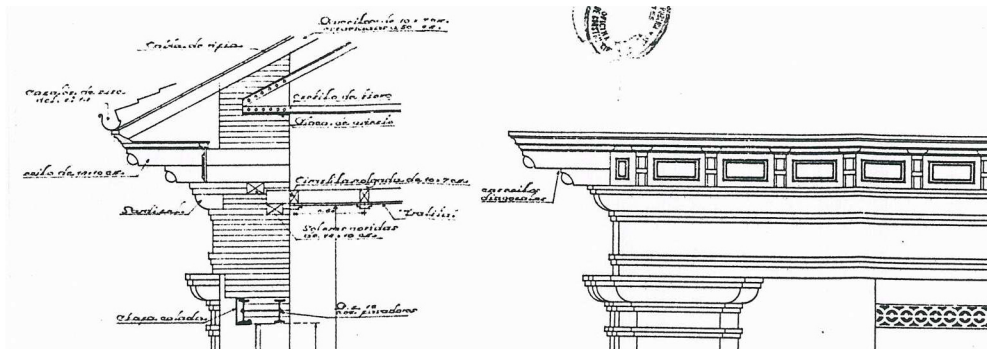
5. Sección constructiva de los planos originales. Imagen extraída de (Rodríguez 2008)
